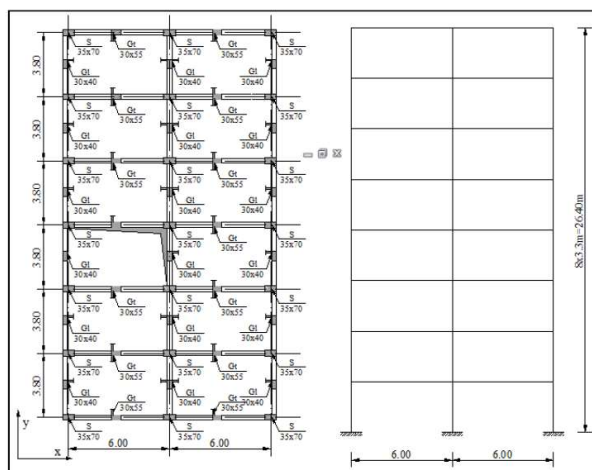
Plan cofraj niveluri 1-4 pentru structura existentă
